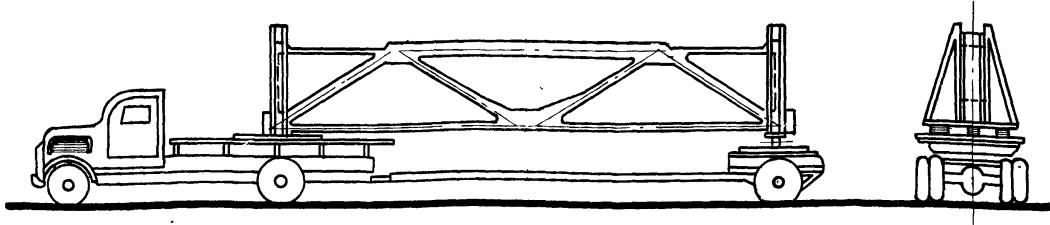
СХЕМА ПЕРЕВОЗКИ ФЕРМЫ НА АВТОМАШИНЕ С ПРИЦЕПОМ
